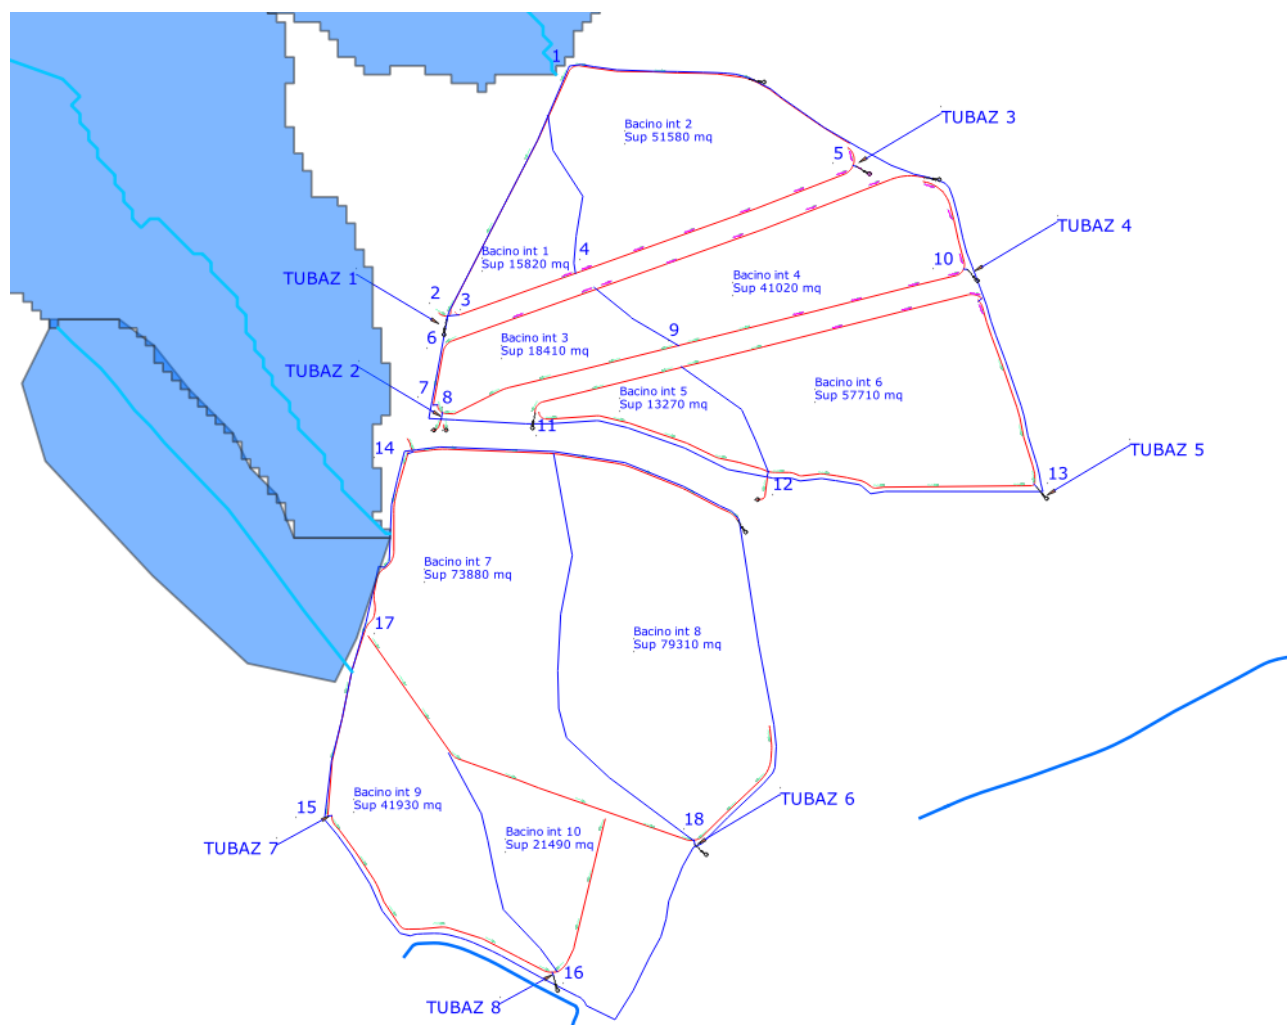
Planimetrie con individuazione dei tratti oggetto di verifica
